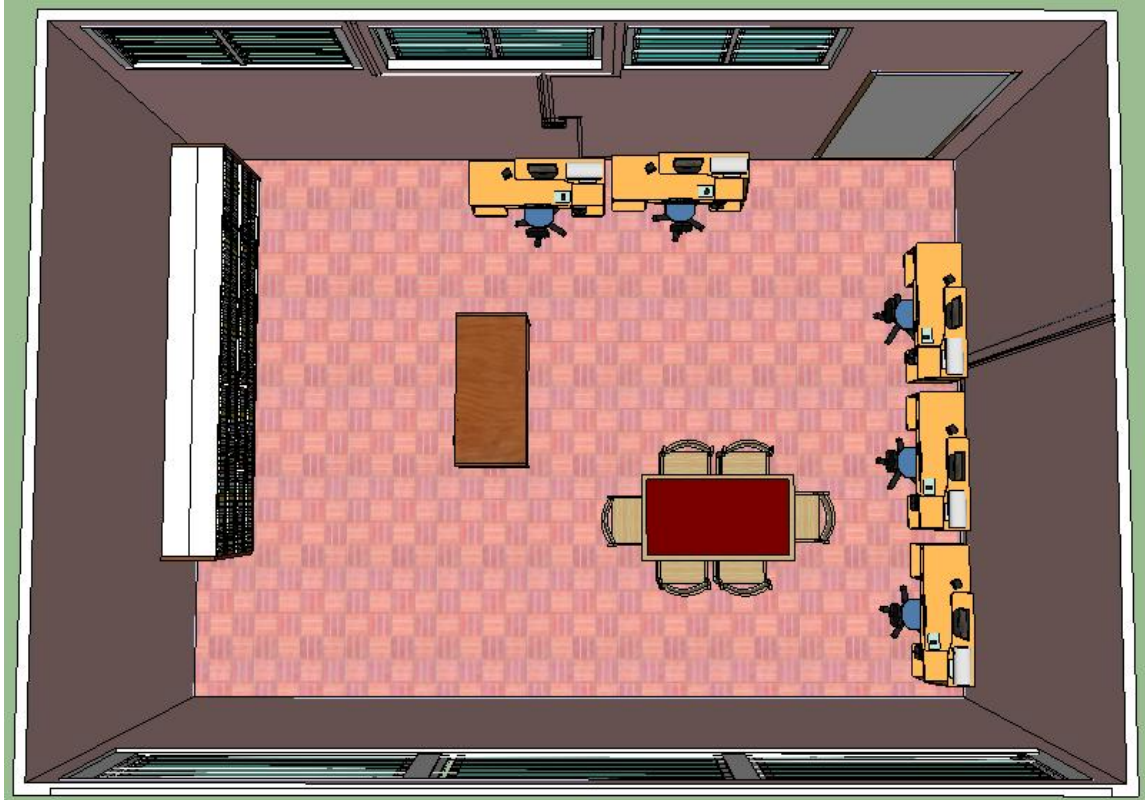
N: Vista en planta de la Biblioteca del Bachillerato Industrial
